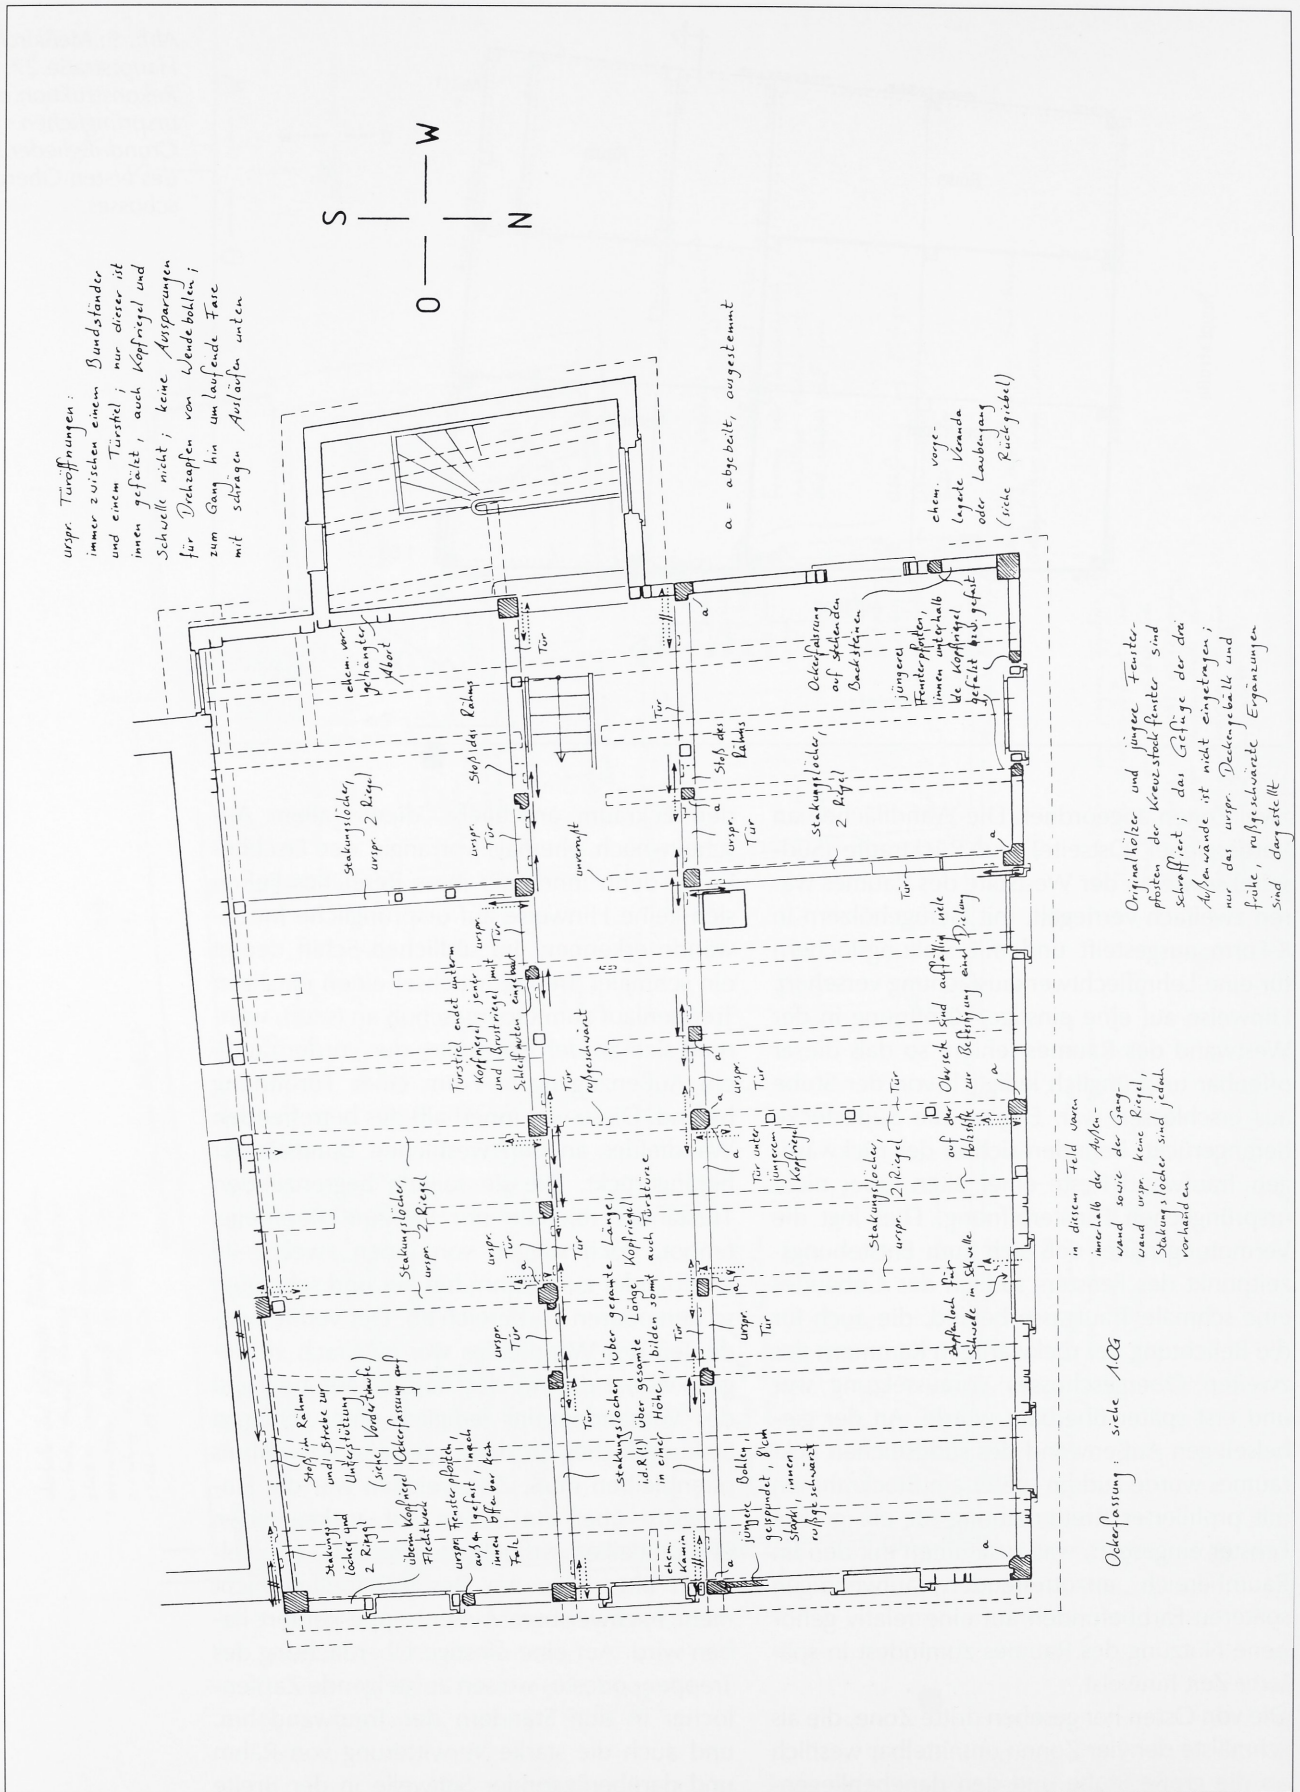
Meßkirch, Hauptstraße 27. Rekonstruktion der ursprünglichen Grundrißgliederung des ersten Obergeschosses.
